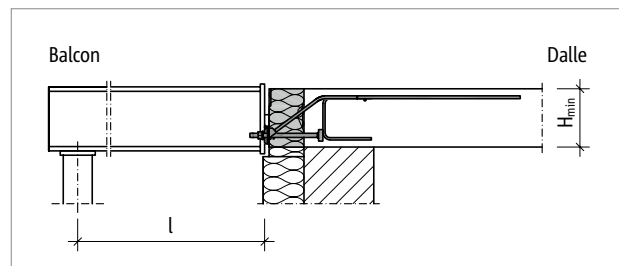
Schöck Isokorb® XT type SQ : système statique
